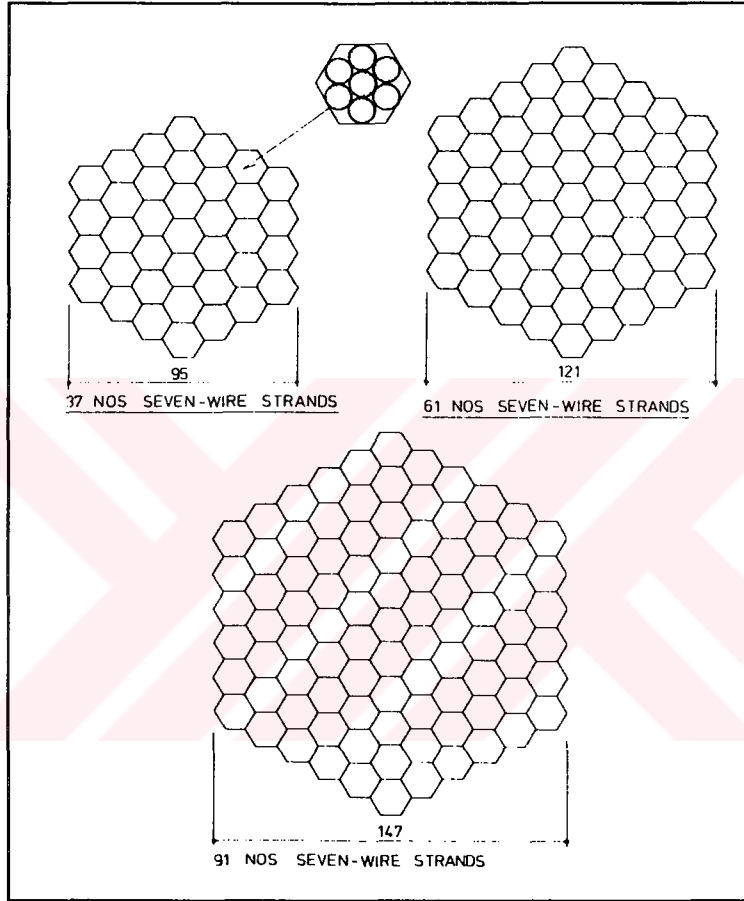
Parana Köprüsünde kullanılan paralel-tel halatı.
